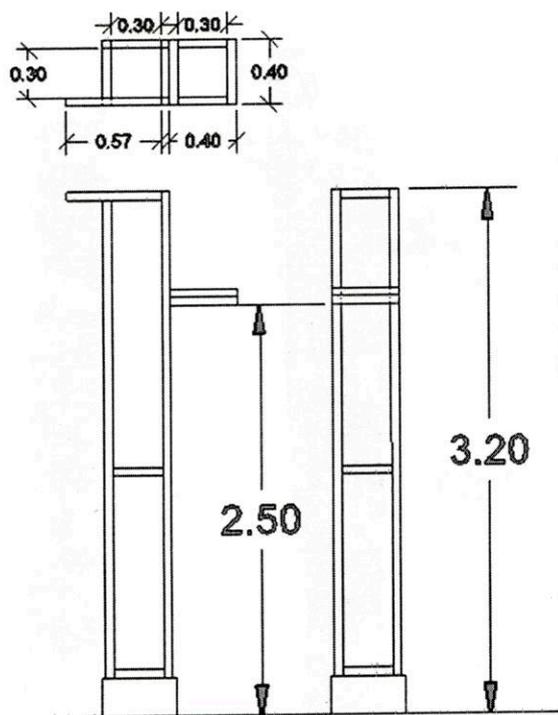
Esquema de estructura, en planta y vista. Se deben tener en cuenta los rigidizadores, anclajes y uniones necesarios para garantizar la integridad estructural tal como está previsto en el pliego.
